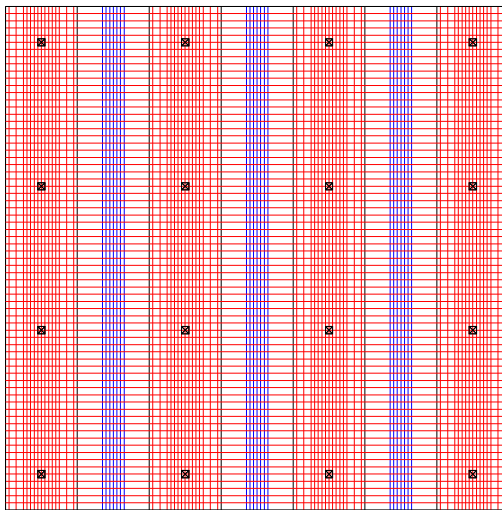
Alternativa de traçado 4 dos cabos no pavimento com balanço
